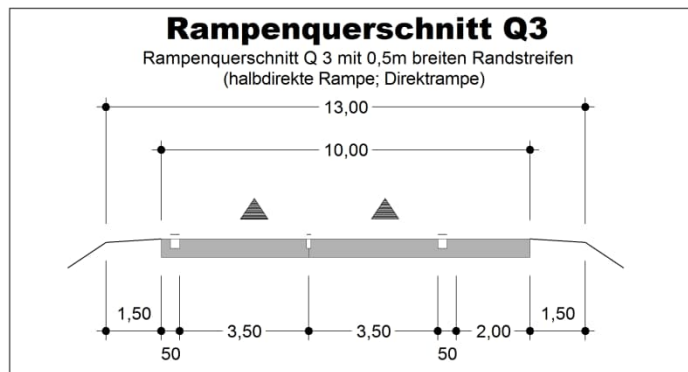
Rampenquerschnitt Q3 Direktrampe Berlin – Heilbronn nach Trennung mit Rampe Berlin – B4 (Nürnberg)
